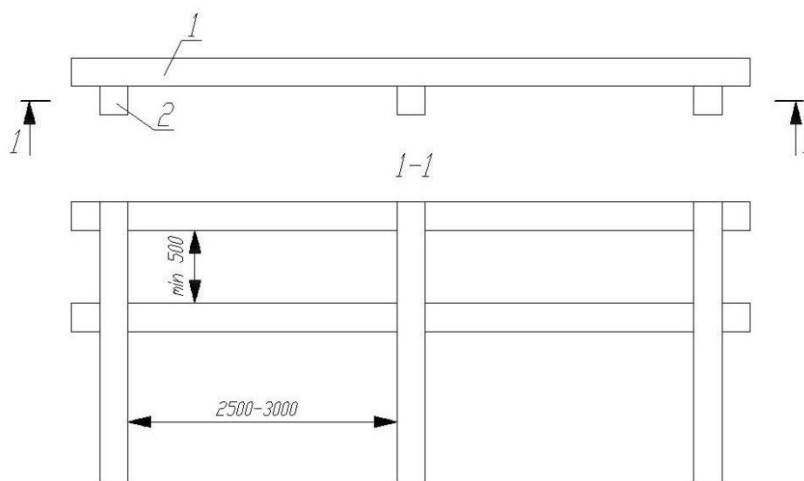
Кондуктор для погружения шпунта ПВХ
